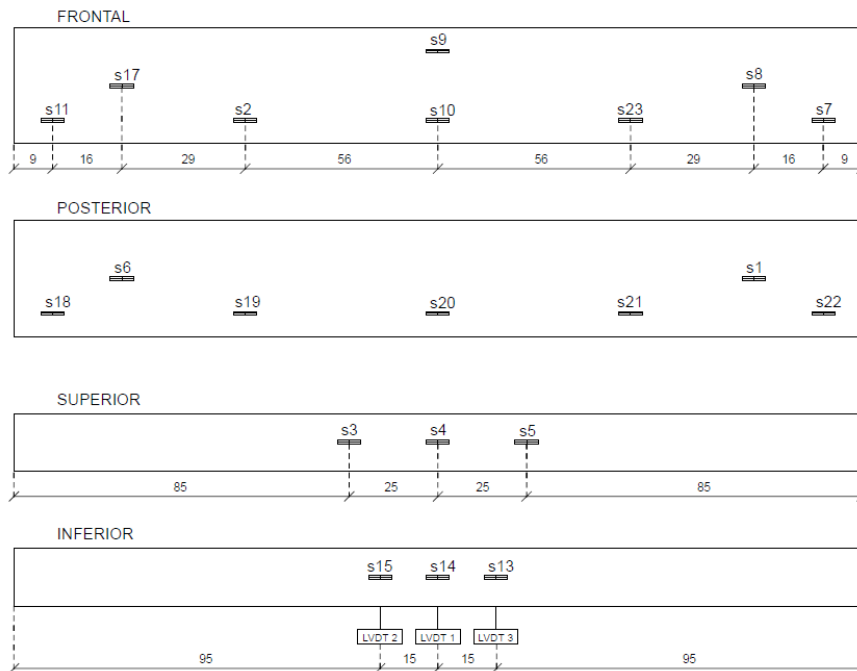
Instrumentação do concreto da viga 2 (medidas em cm)
